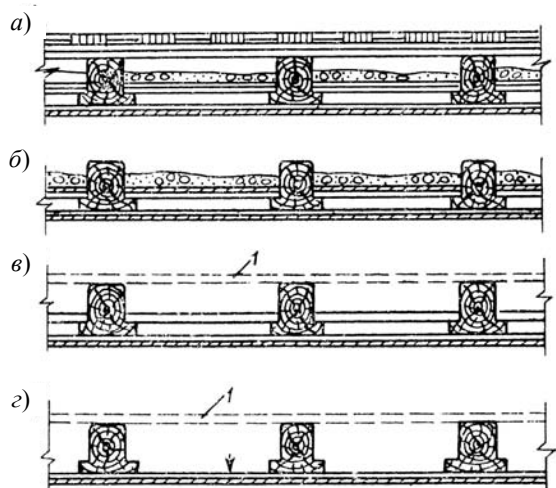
Последовательность разборки элементов междуэтажного перекрытия: *а* – междуэтажное перекрытие после разборки перекрытия потолка; *б* – перекрытие после снятия пола с основания; *в* – перекрытие после удаления засыпки; *з* – перекрытие после разборки наката и подшивки потолка и штукатурки; *1* – временный настил
